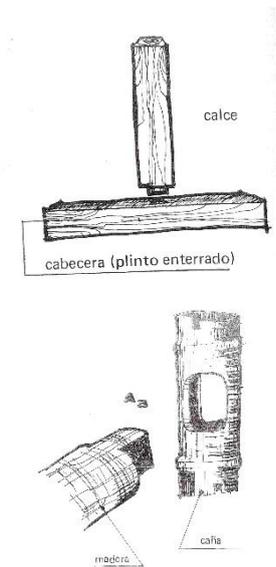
Arriba detalle cimentación, abajo ensamble de caña y madera. (pág. 148)
